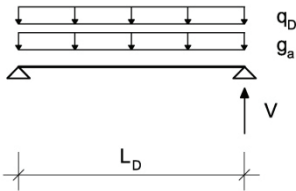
Statisches System des Slim-Floor Trägers
